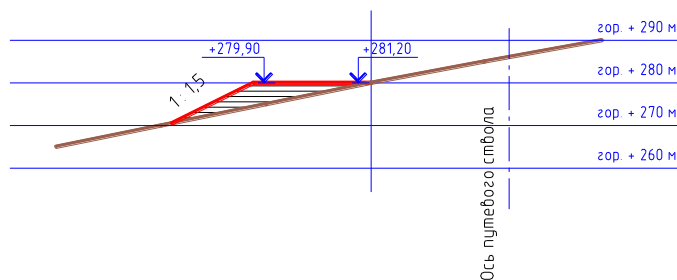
Поперечный разрез 2-2 площадки 2
